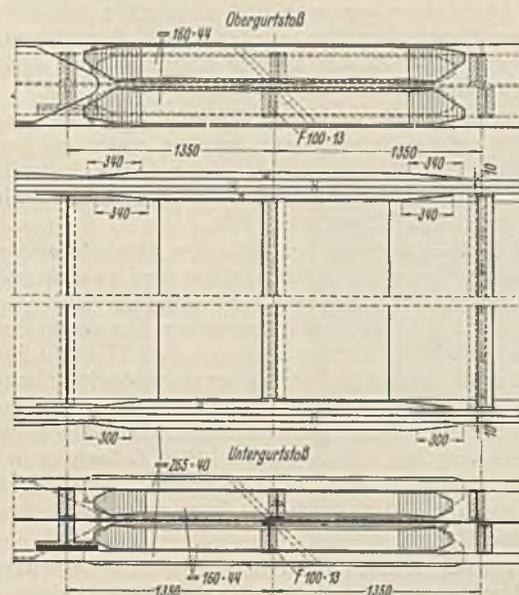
Hauptträgerstoß der Eisenbahnbrücke (Anteil Krupp).
